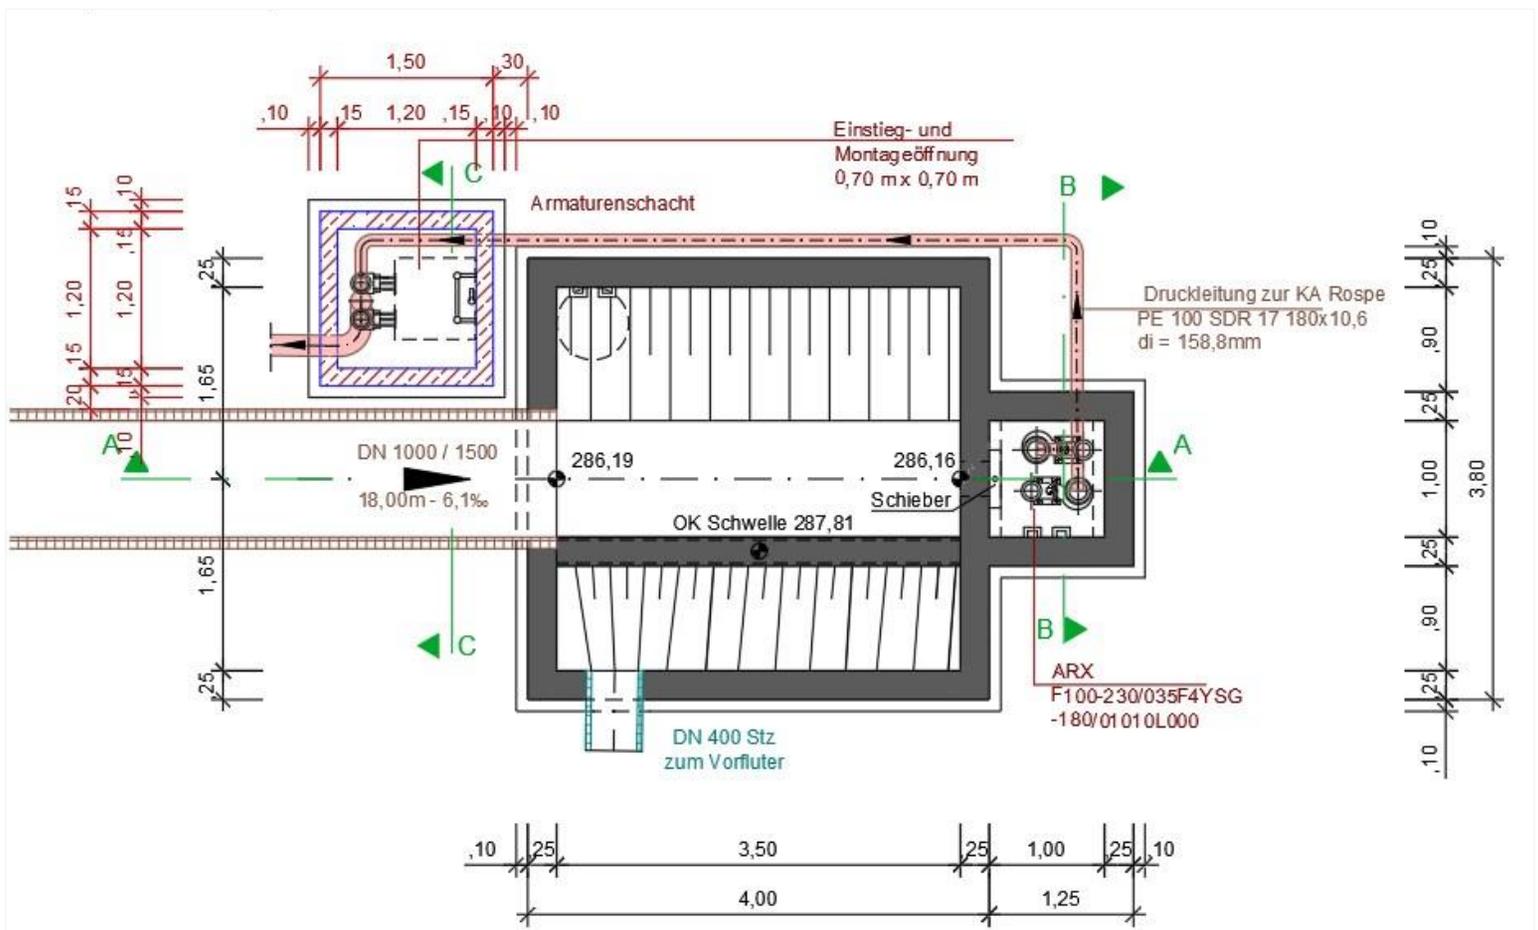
Lageplan RÜB und geplantes RRB Dannenberg
